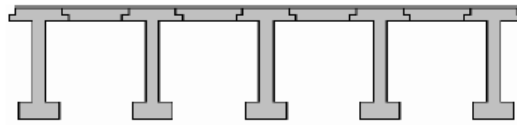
Puente de gran longitud con pilas intermedias (Alvarado C., 2004)
